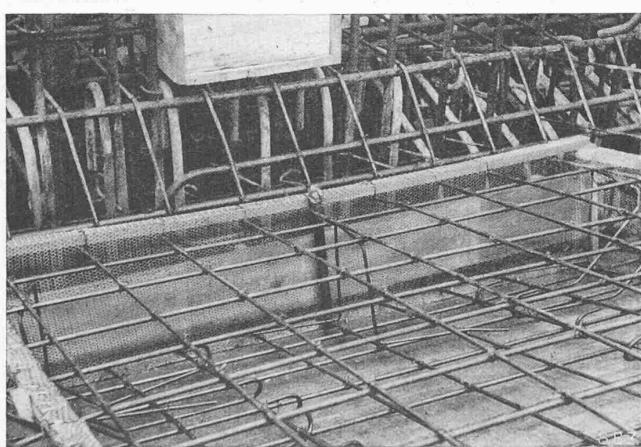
Los 4: Bewehrung der unteren Druckplatten und Herstellung der Betonierfugen mit Streckmetall zur Erzielung eines guten Beton-Verbandes
